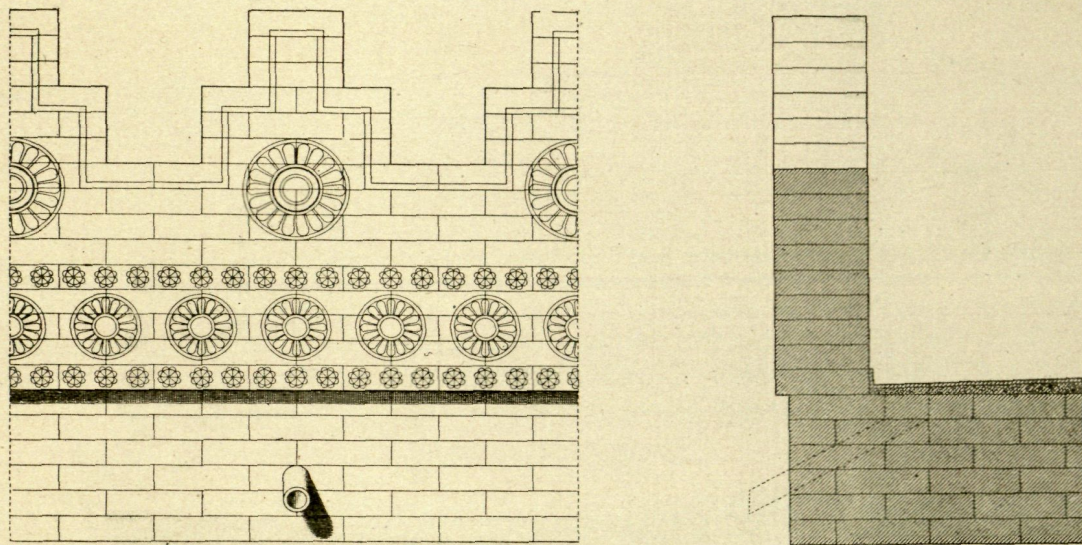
PARAPETO ALMENADO DEL ZIGURAT DE SARGÓN EN KHORSABAD. - ALZADO Y SECCIÓN (SEGÚN THOMAS)
